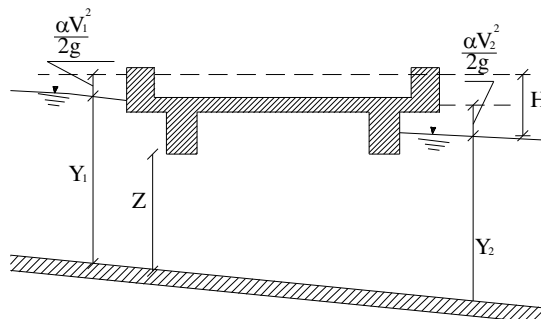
Sezione schematica di un ponte - Schema di calcolo
